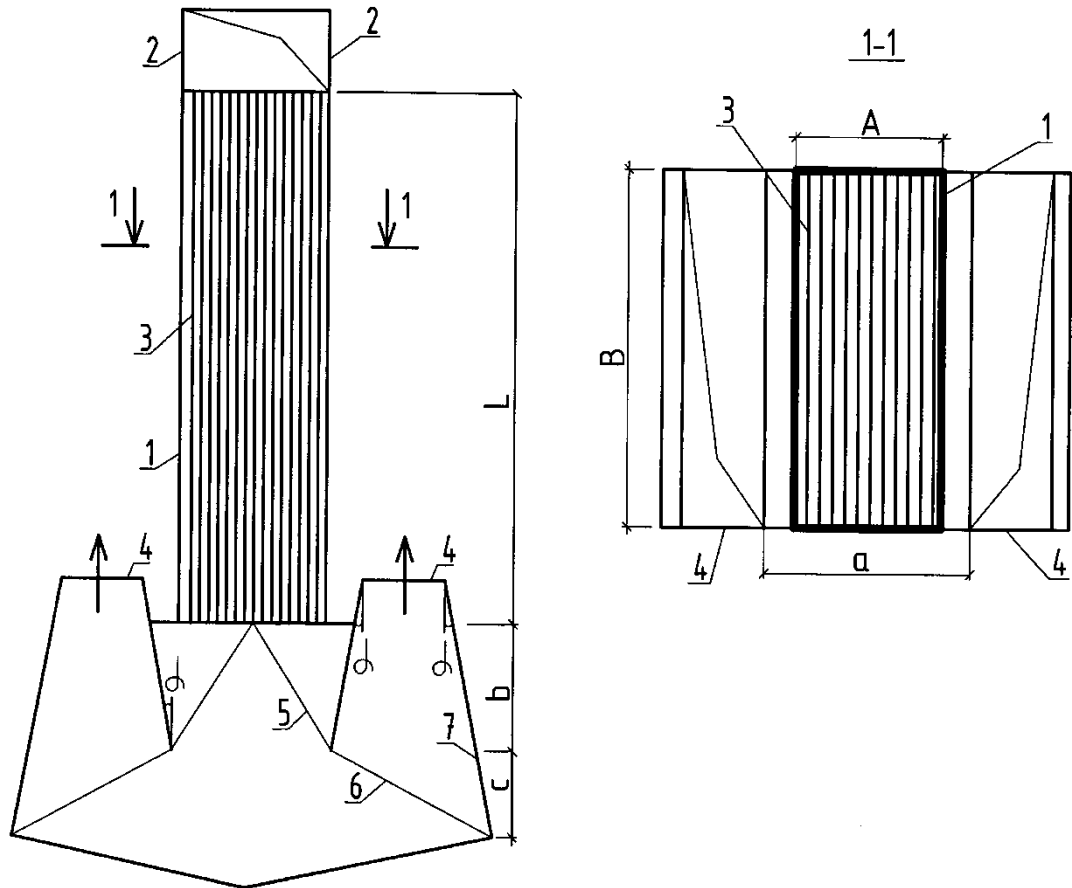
Пластинчатый сепаратор аэрозоля: 1-корпус сепаратора, 2-воздуховод равномерной раздачи, 3-плоские пластины, 5-сетки-укрупнители капель, 7-бункер, 6-сетка, 4-стабилизирующие конфузорные патрубки.
